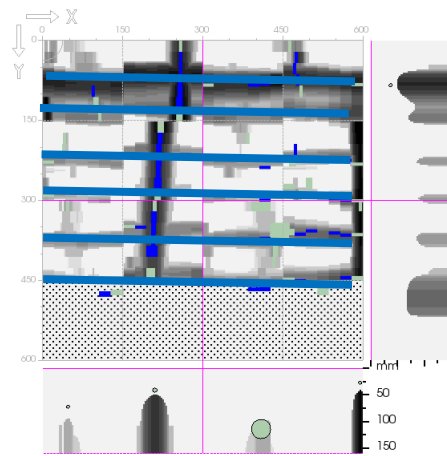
Poutre Pt04 – Travée 2 à mi-travée
